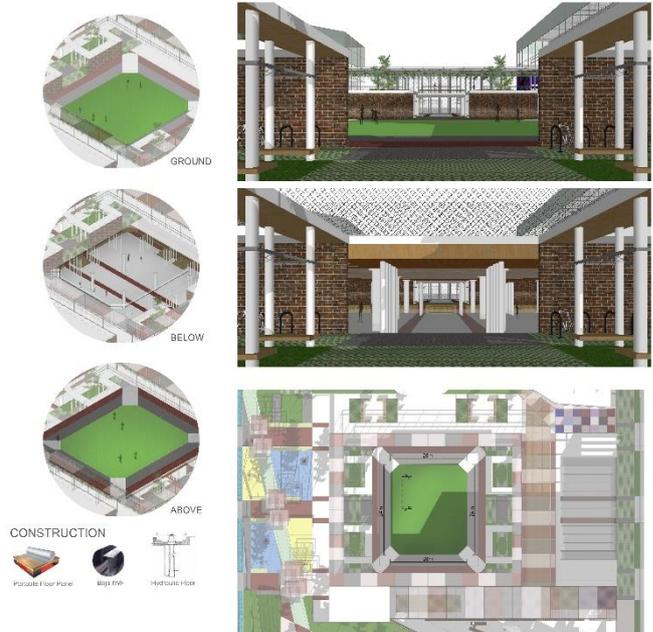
Detil konstruksi lantai *hydraulic
